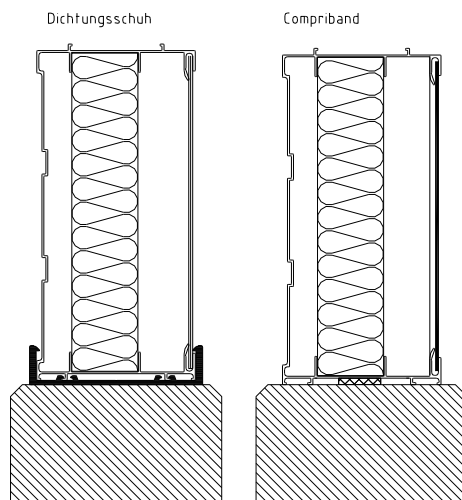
Auflagerung auf Sockelelementen aus Stahlbeton
